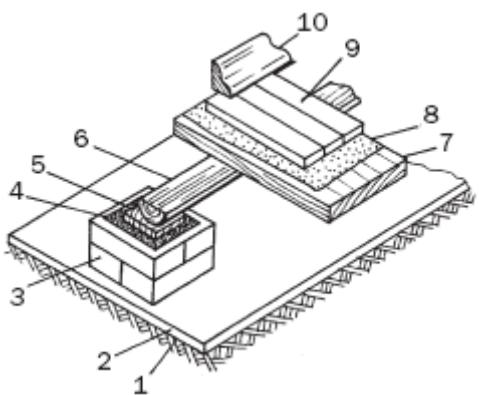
Дощатый пол на грунтовом основании: 1 – утрамбованный грунт основания; 2 – слой из щебенки и бетона; 3 – кирпичный столбик; 4 – слой толя; 5 – подкладки; 6 – лаги; 7 – дощатый пол; 8 – слой подложки для паркета или ламината; 9 – паркетный пол; 10 – плинтус
